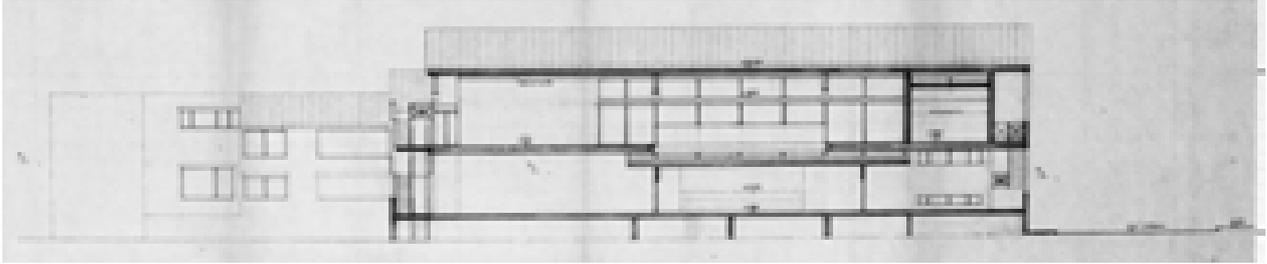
Sezione DD, stato futuro –12/09/1984 (AABS-1996.223)
